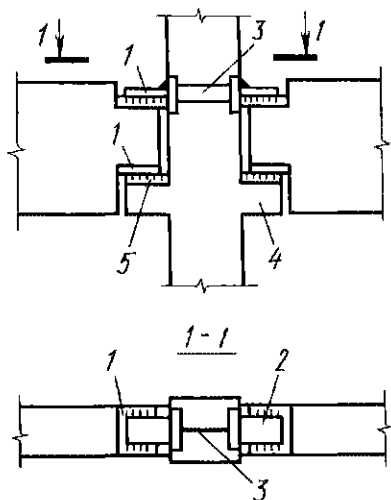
Шарнирный стык ригелей на прямоугольных консолях с жесткой арматурой
